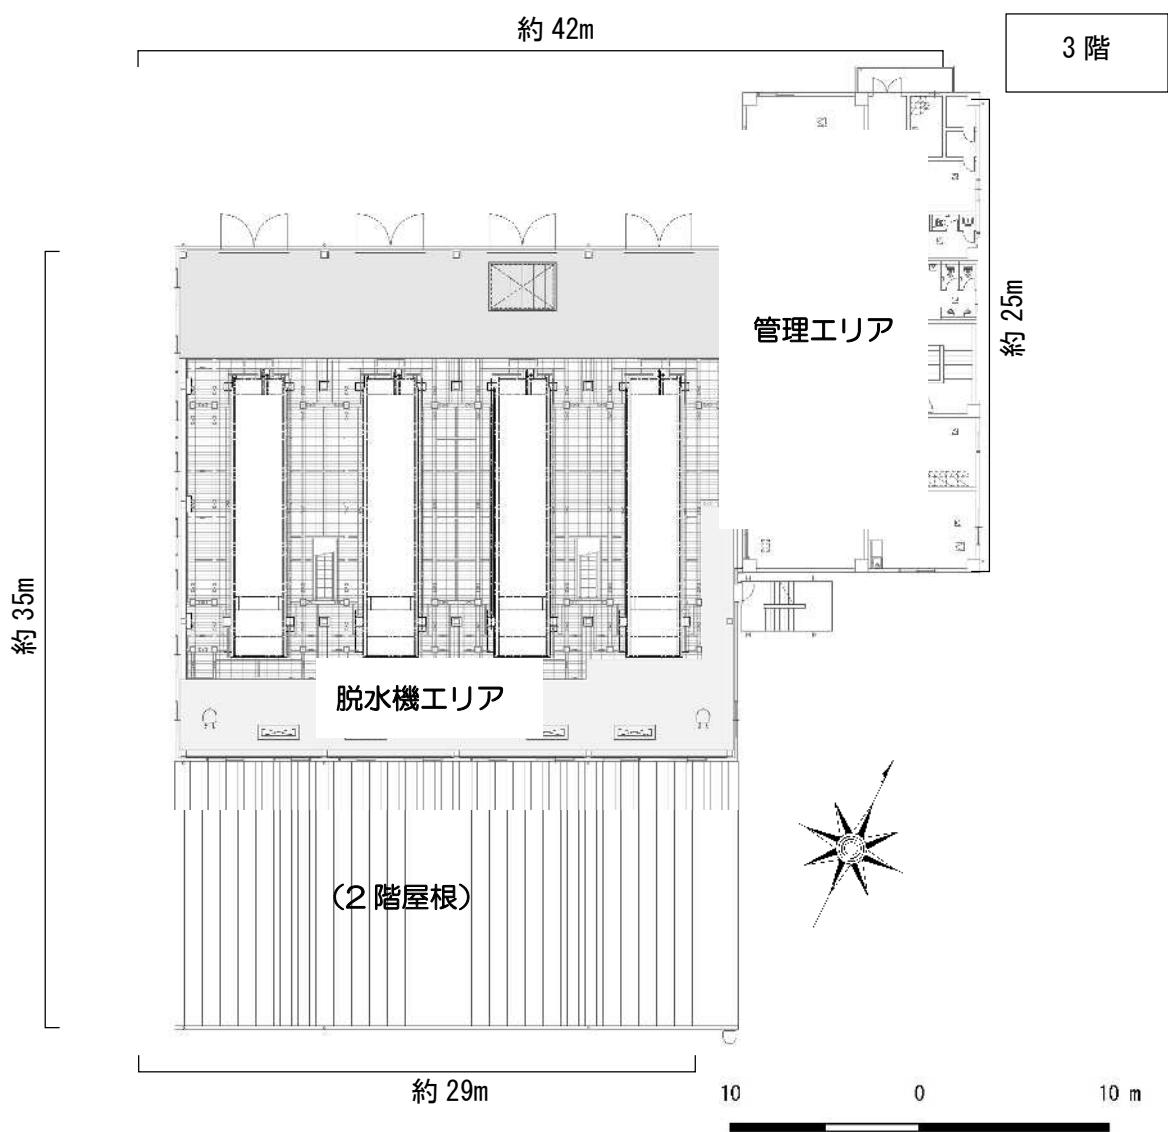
(3) 3 階平面図 (縮尺 1:400)
